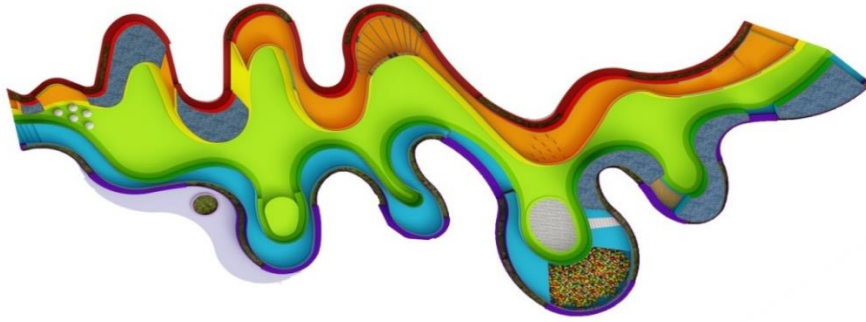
Renklerin Akışı isimli oyun alanının plan ve görünüşü (Sena, Ş., 2022, Orijinal)
